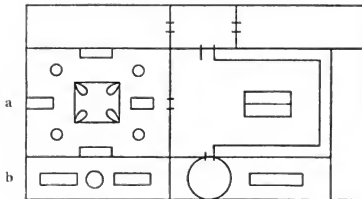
Brauhaus auf dem Grundrisse zu St. Gallen.
